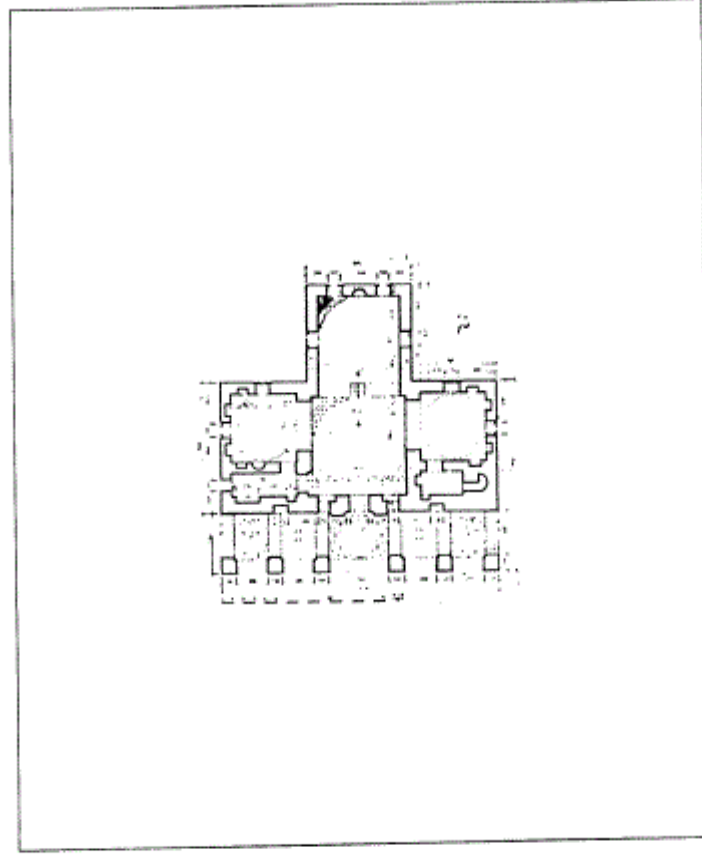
مسقط أفقي لمسجد الأجا (عمارت) إسحاق بك في أسكوب
